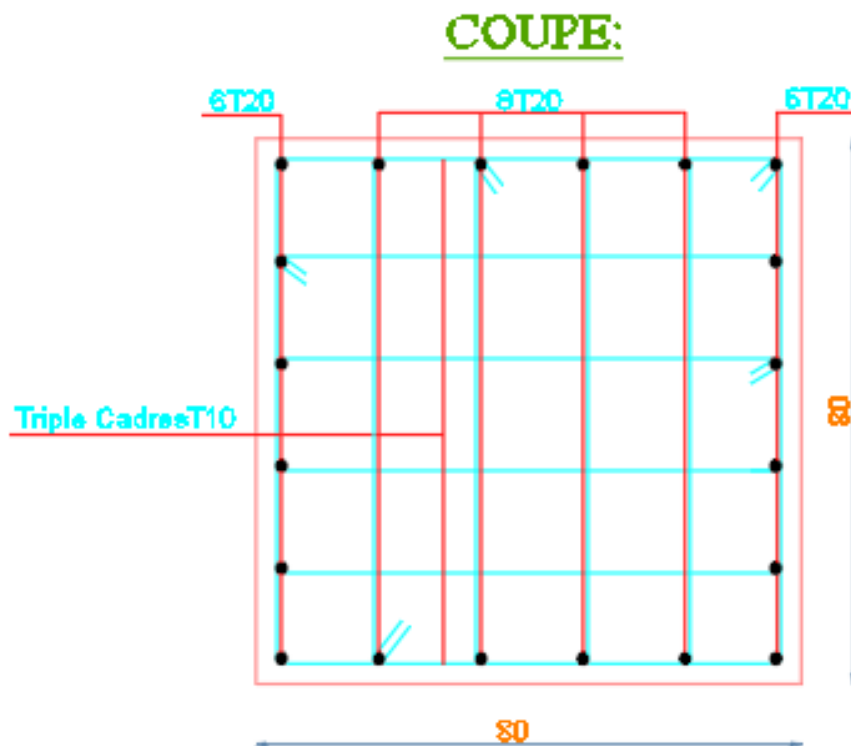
Schéma du ferrailage du poteau (80x80) cm²
